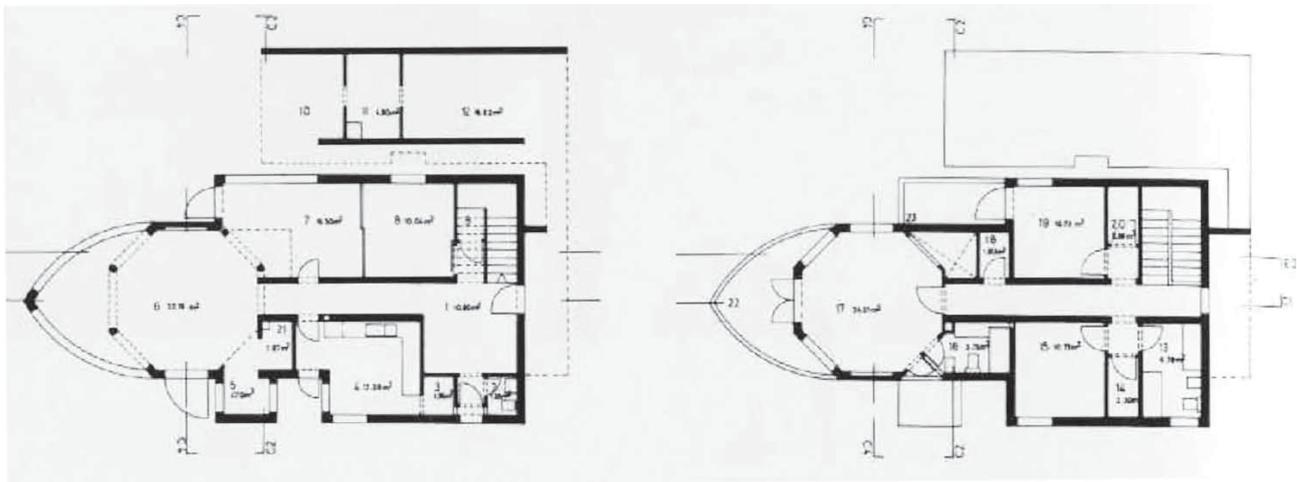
Plantas baixas da casa Figueiredo. Fonte: AUTOR, 2002.
